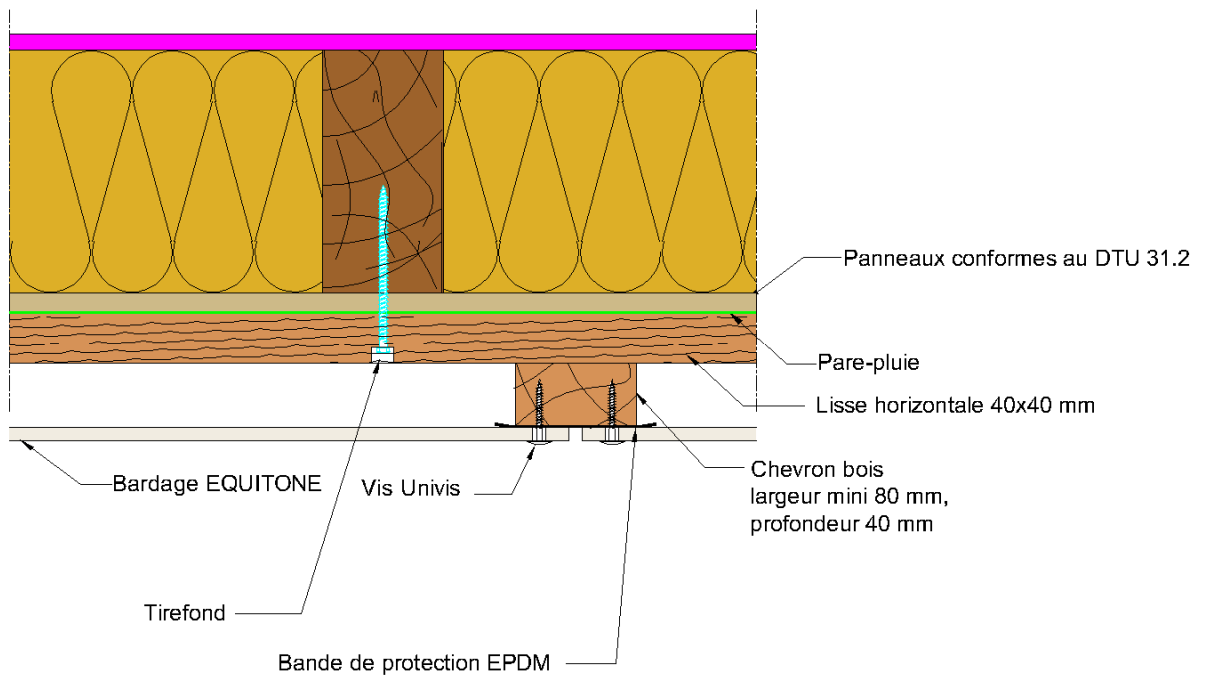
Principe de fixation sur chevron intermédiaire – Pose sur COB
